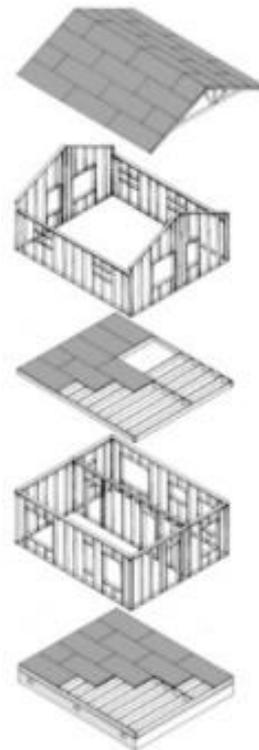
Sección constructiva sistema Platform Frame (Dibujo original)
